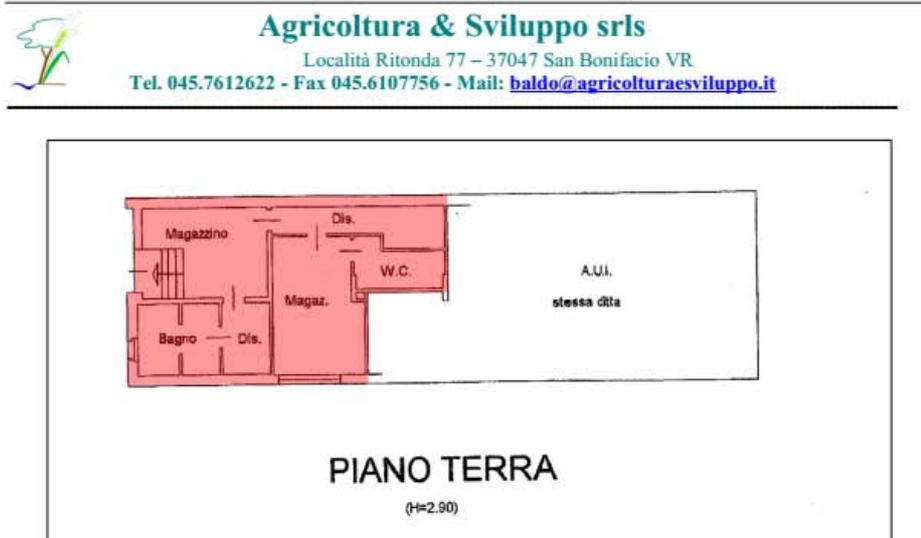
Estratto di planimetria: Lonigo, foglio 2 mappali 100 – sub. 10 con evidenziato in rosso la porzione di fabbricato oggetto di intervento
